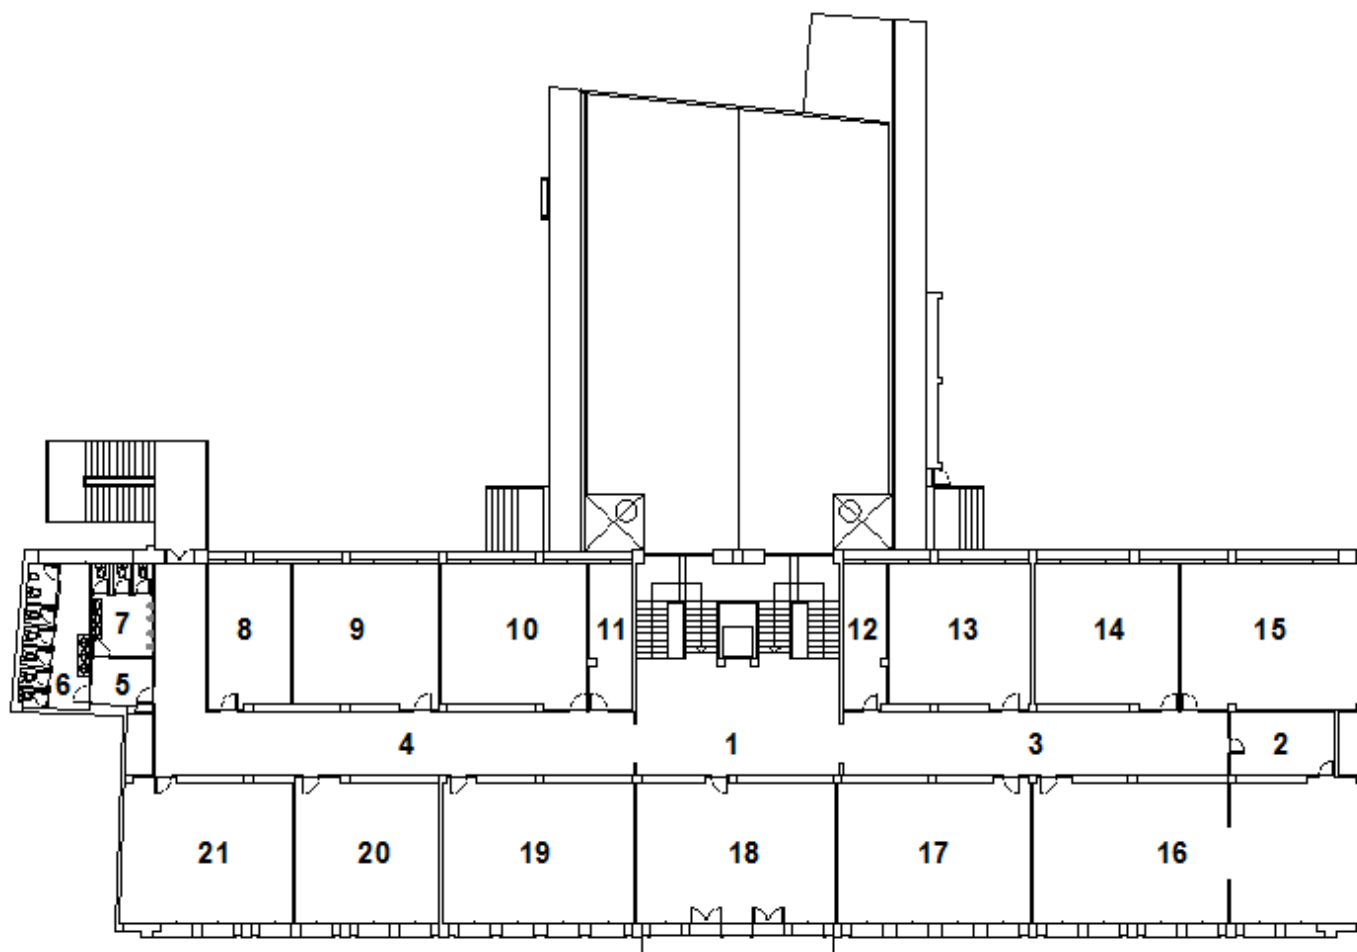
Distribución planta segunda. Fuente: Elaboración propia.
